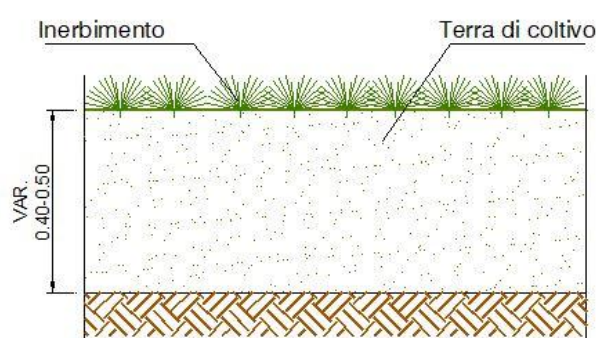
Sezione di terreno sottoposto a inerbimento.
